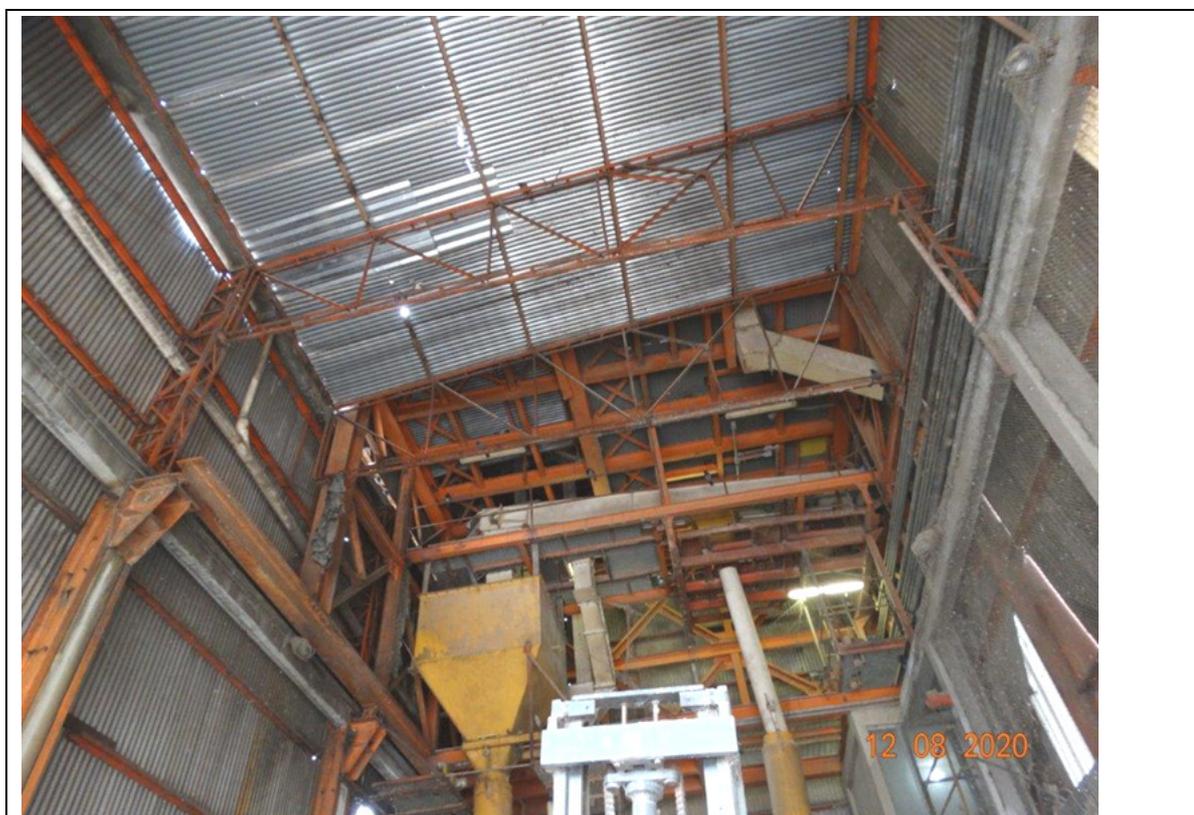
COBERTURA DA FOTO ANTERIOR.
